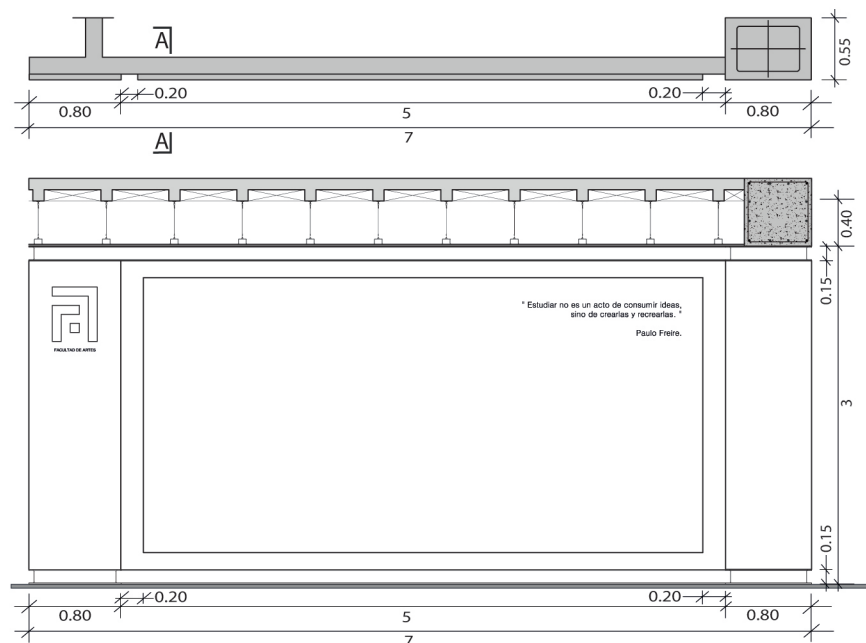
Planta, elevaciones y secciones. Estanterías. M-08b.
